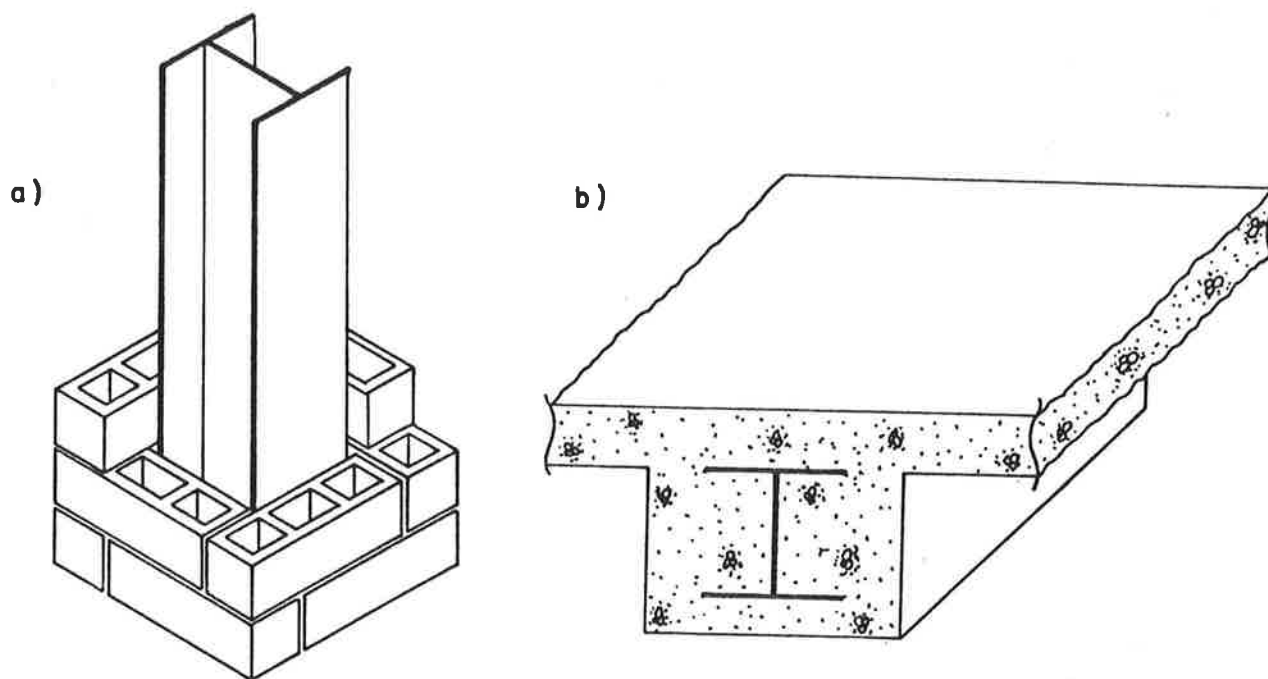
A proteção por encapsulamento convencional: a) contorno de pilar com alvenaria; b) viga envolvida por concreto.
